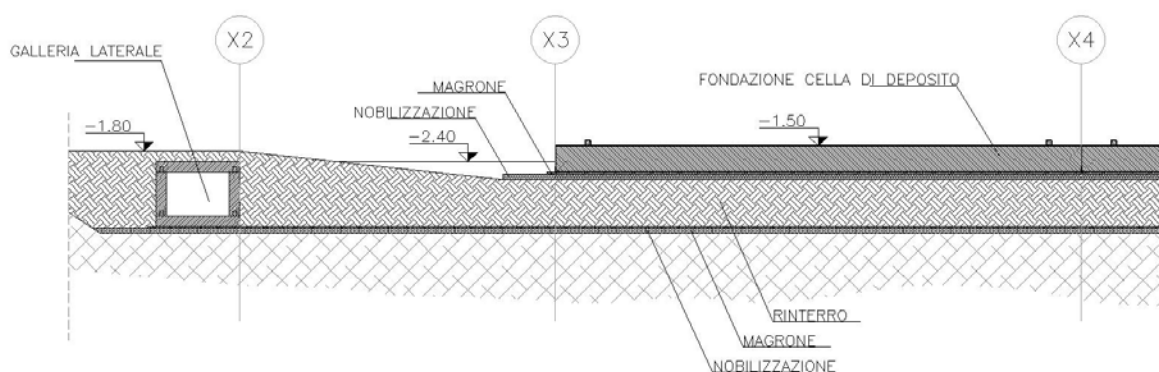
Sezione longitudinale fondazioni Cella di Deposito
